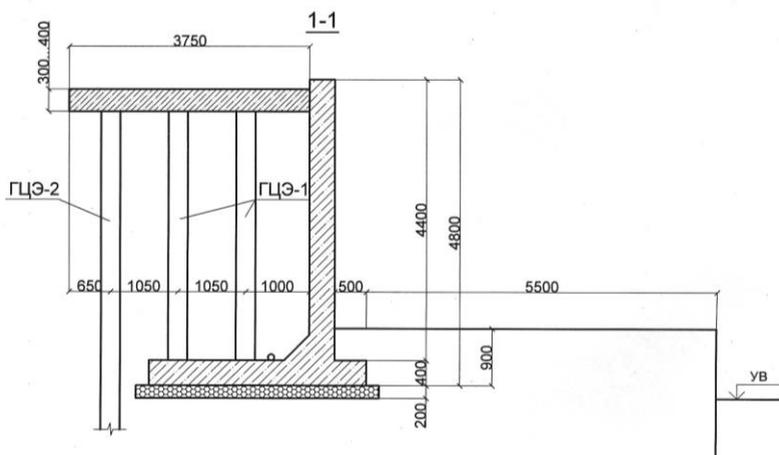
Поперечный разрез по плану размещения ГЦЭ
